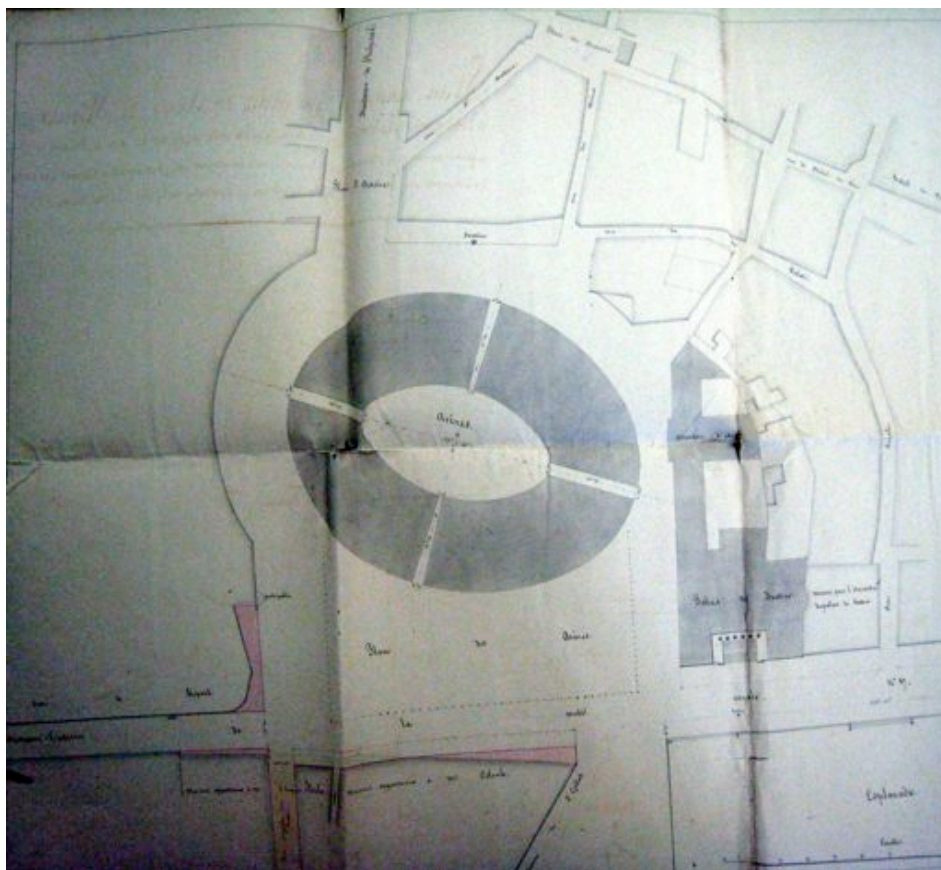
Plan général de la place des Arènes de Nîmes et d'une partie de la traversée de la ville, par la route royale, n°87 de Lyon à Béziers, à joindre au rapport de l'ingénieur en chef du Gard sur l'alignement qu'il paraît convenable d'assigner à la façade des bâtiments que Mr Eugène Foulc se propose de construire sur le bord de la route. Vinard, ingénieur, 1839 - (ADG)
